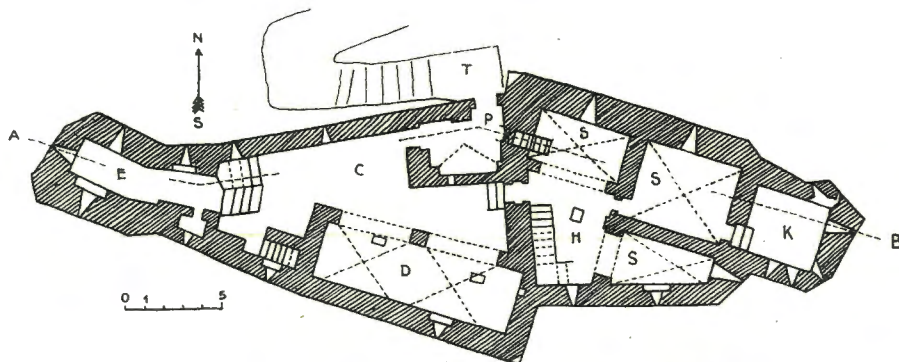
Plan du château d'el-Musailiha au rez-de-chaussée.
